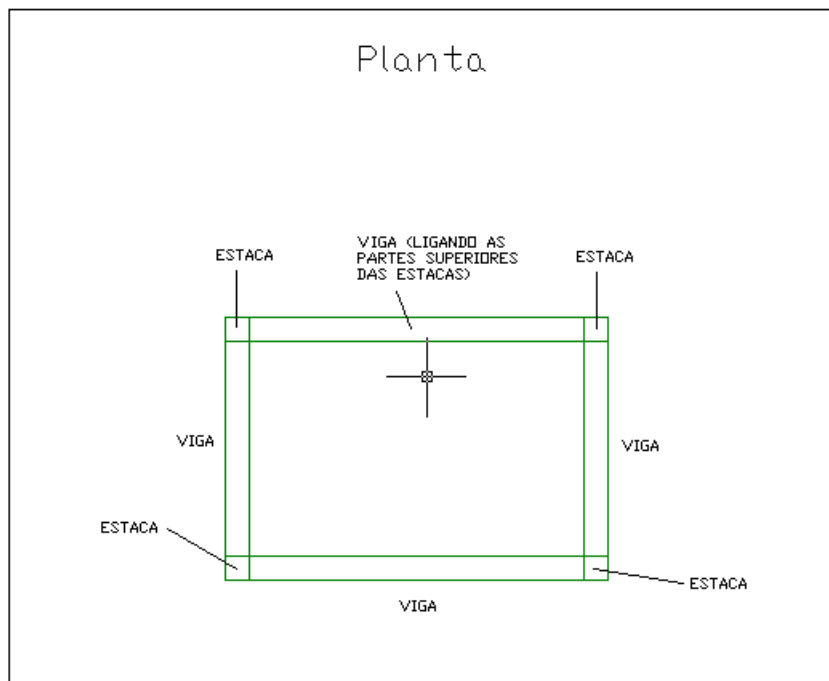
representação esquemática em planta da ligação vigas-baldrame/estacas
